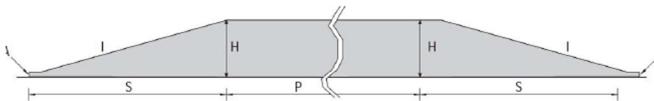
Profil général (trapézoïdal) et éléments caractéristiques d'un plateau avec rampes biseautées planes
